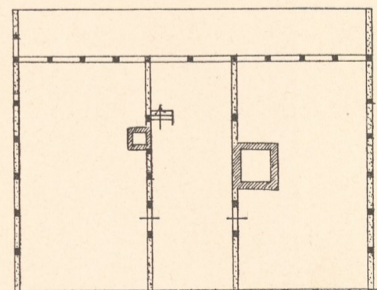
Grundriss LM (in Abb. 19).
